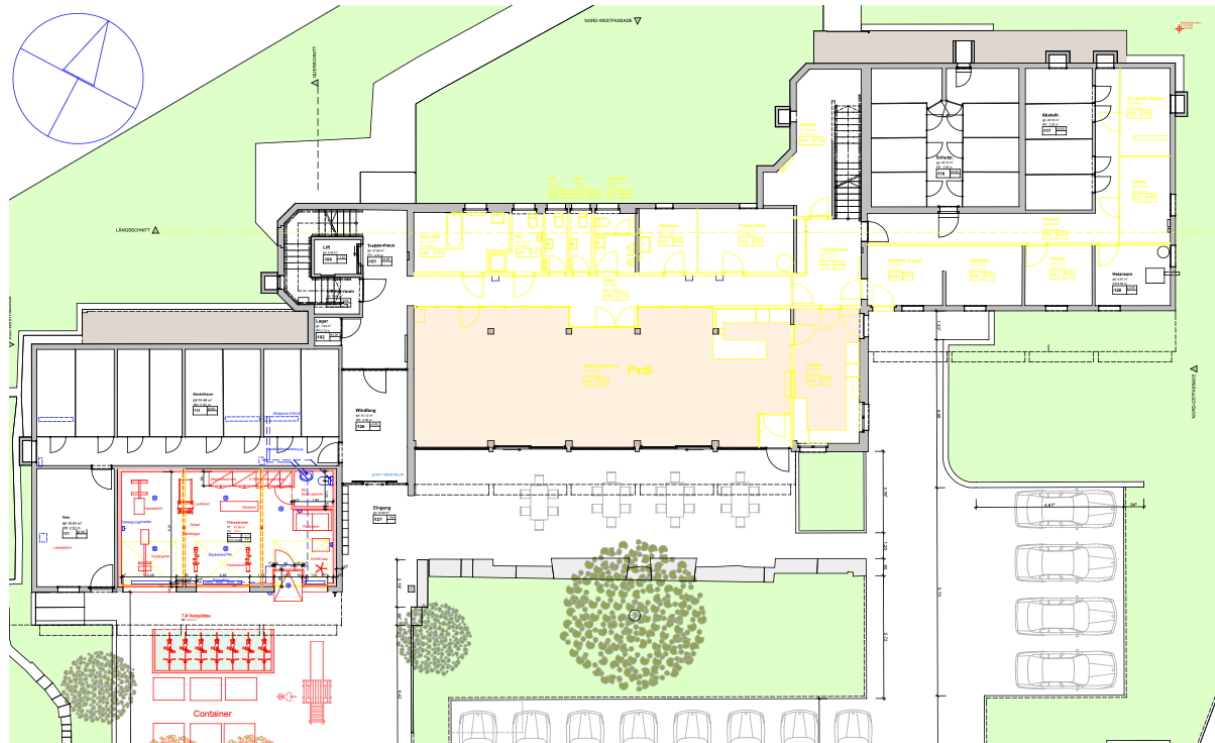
Grundrissplan Haus 8 EG – für Erarbeitung der Varianten
